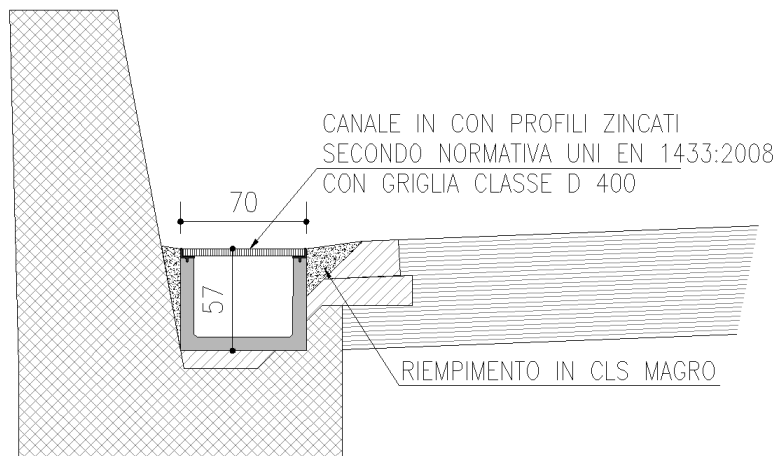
sistemazione di progetto dei cunettoni trapezoidali con installazione canale grigliato prefabbricato
